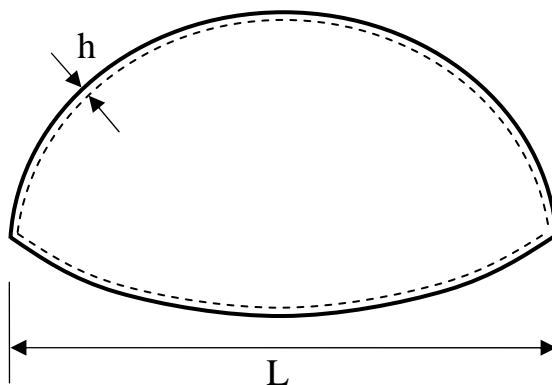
Cúpula de concreto a ser pré-dimensionada.
